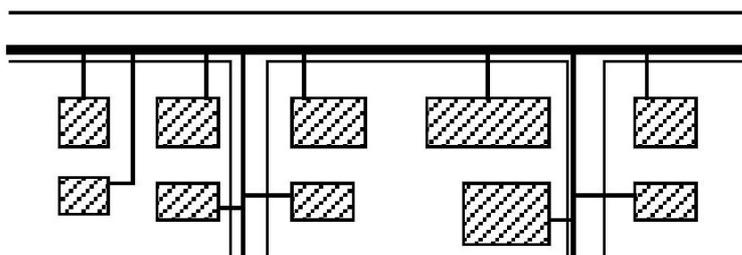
Standard-Trassenführung [2]
